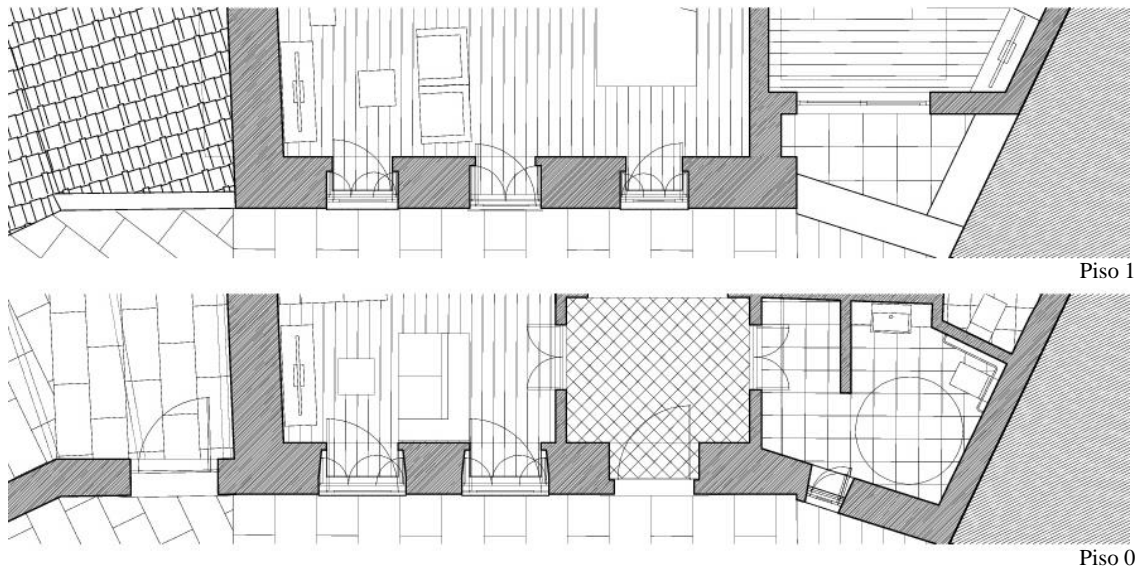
Opção b) esquema de funcionamento em planta e alçado
